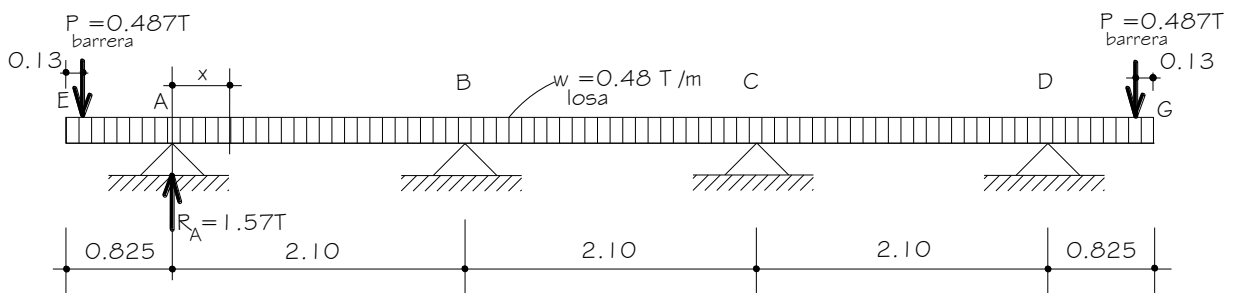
Cargas DC sobre la losa y reacción del apoyo A
